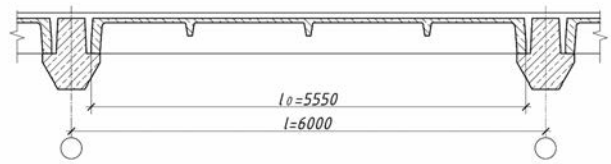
Розрахунковий прогін збірної залізобетонної плити перекриття
